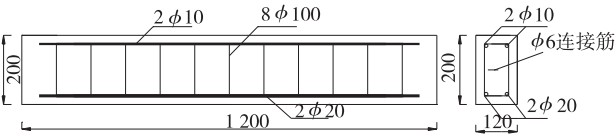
RC 梁尺寸及配筋示意图(单位: mm)
